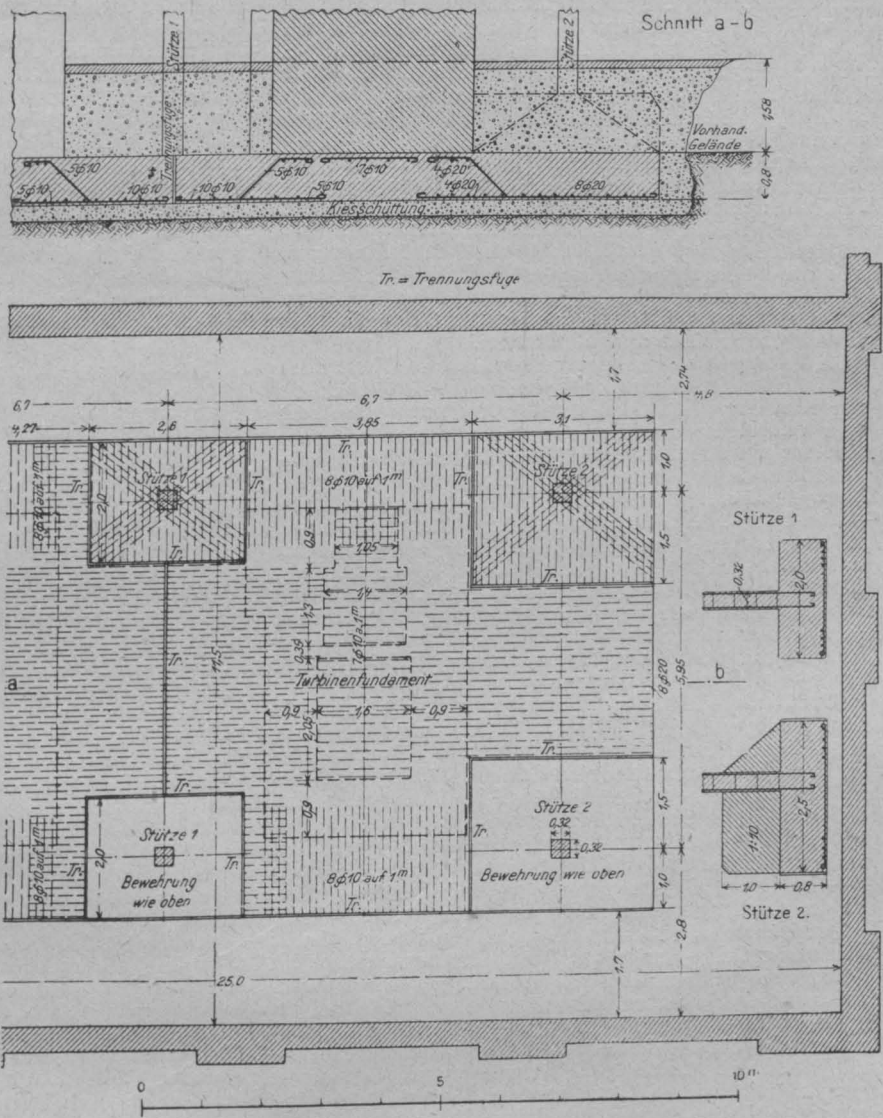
Eisenbeton-Fundamente für Maschinen und Säulen im Turbinenhaus.
